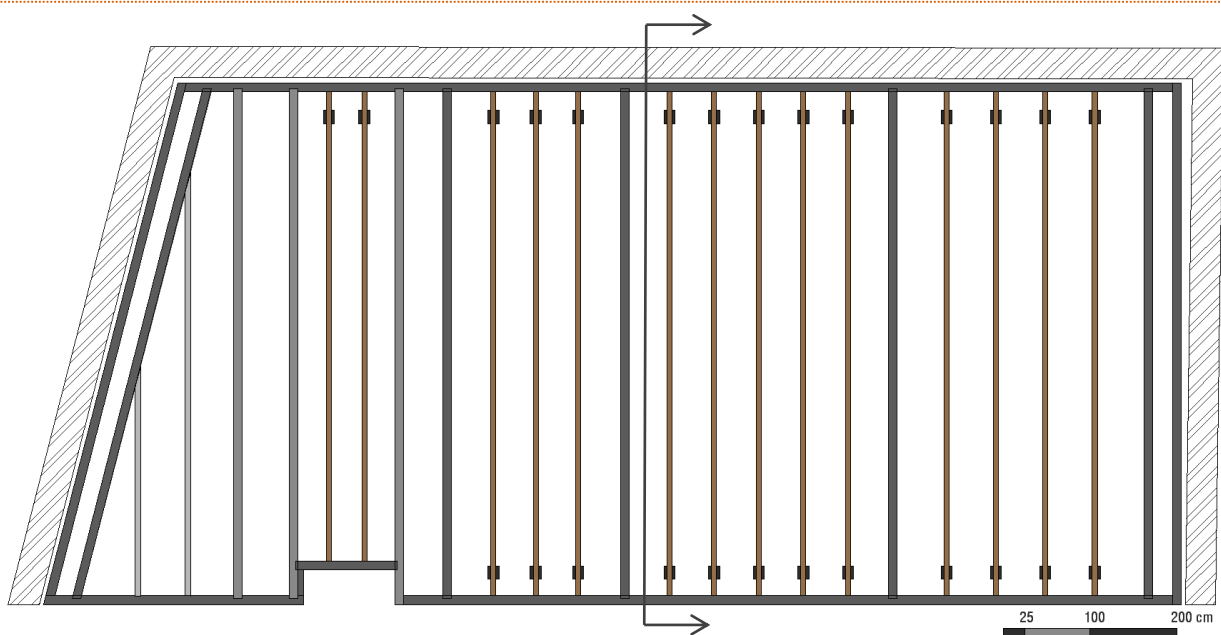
Plan & coupe détail des pilastres et des fondations, mesures en [cm] (Source : Bureau Modelmo, 2010)
